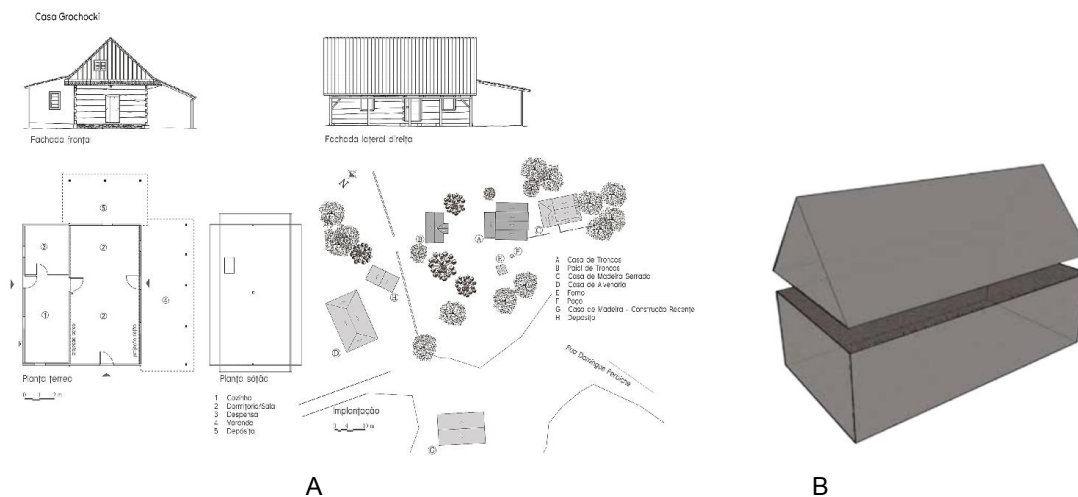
PLANTA E FACHADAS DA CASA GROCHOCKI (A), VOLUMETRIA (B).
